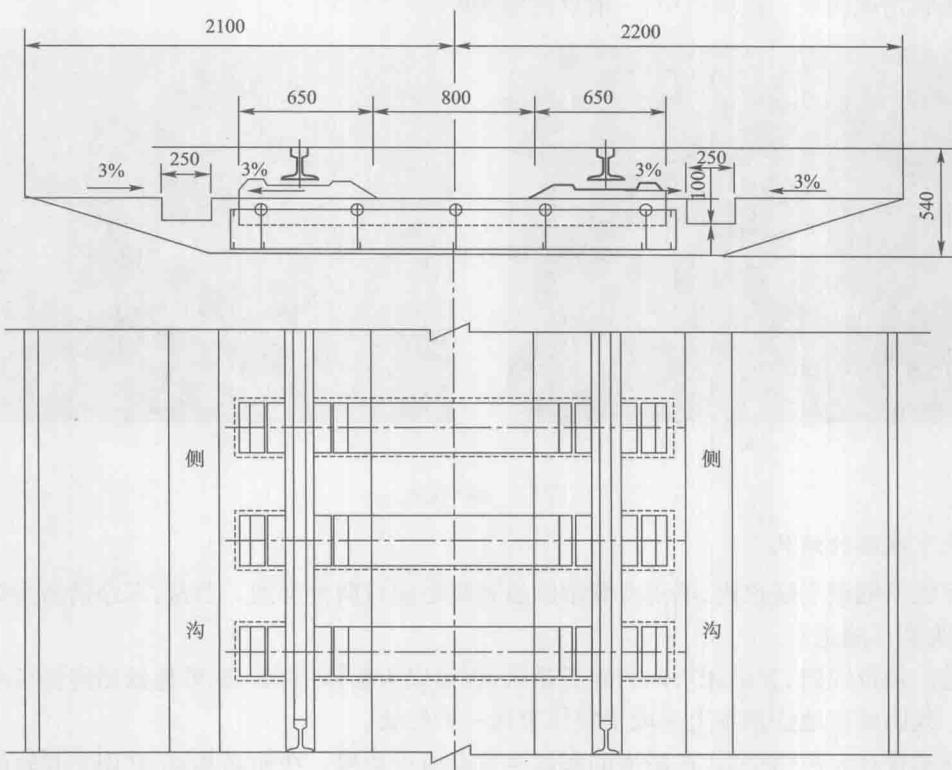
矩形隧道线路断面(尺寸单位:mm)
